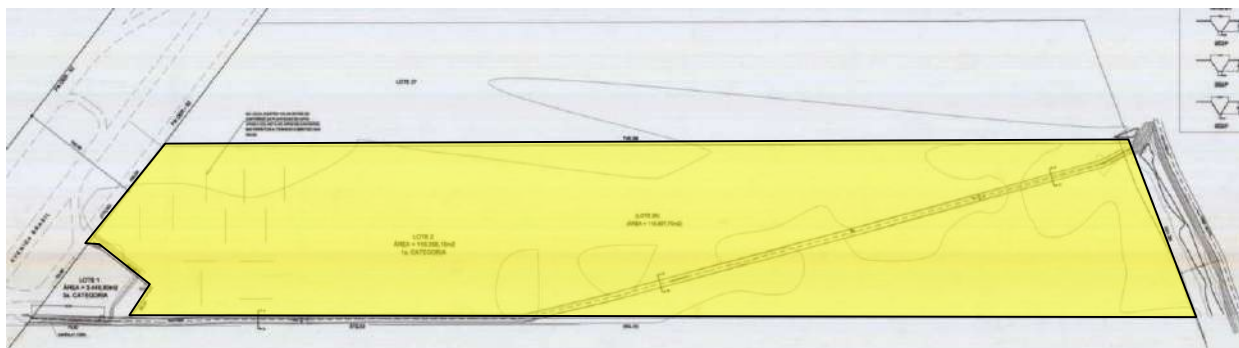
PAL 45.766, com a demarcação do Lote 2 (gleba avalianda)
